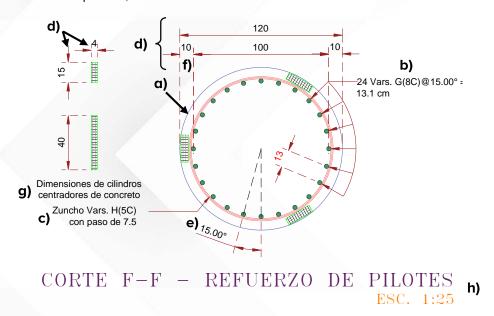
Ejemplo de refuerzo de pilotes, corte F-F
